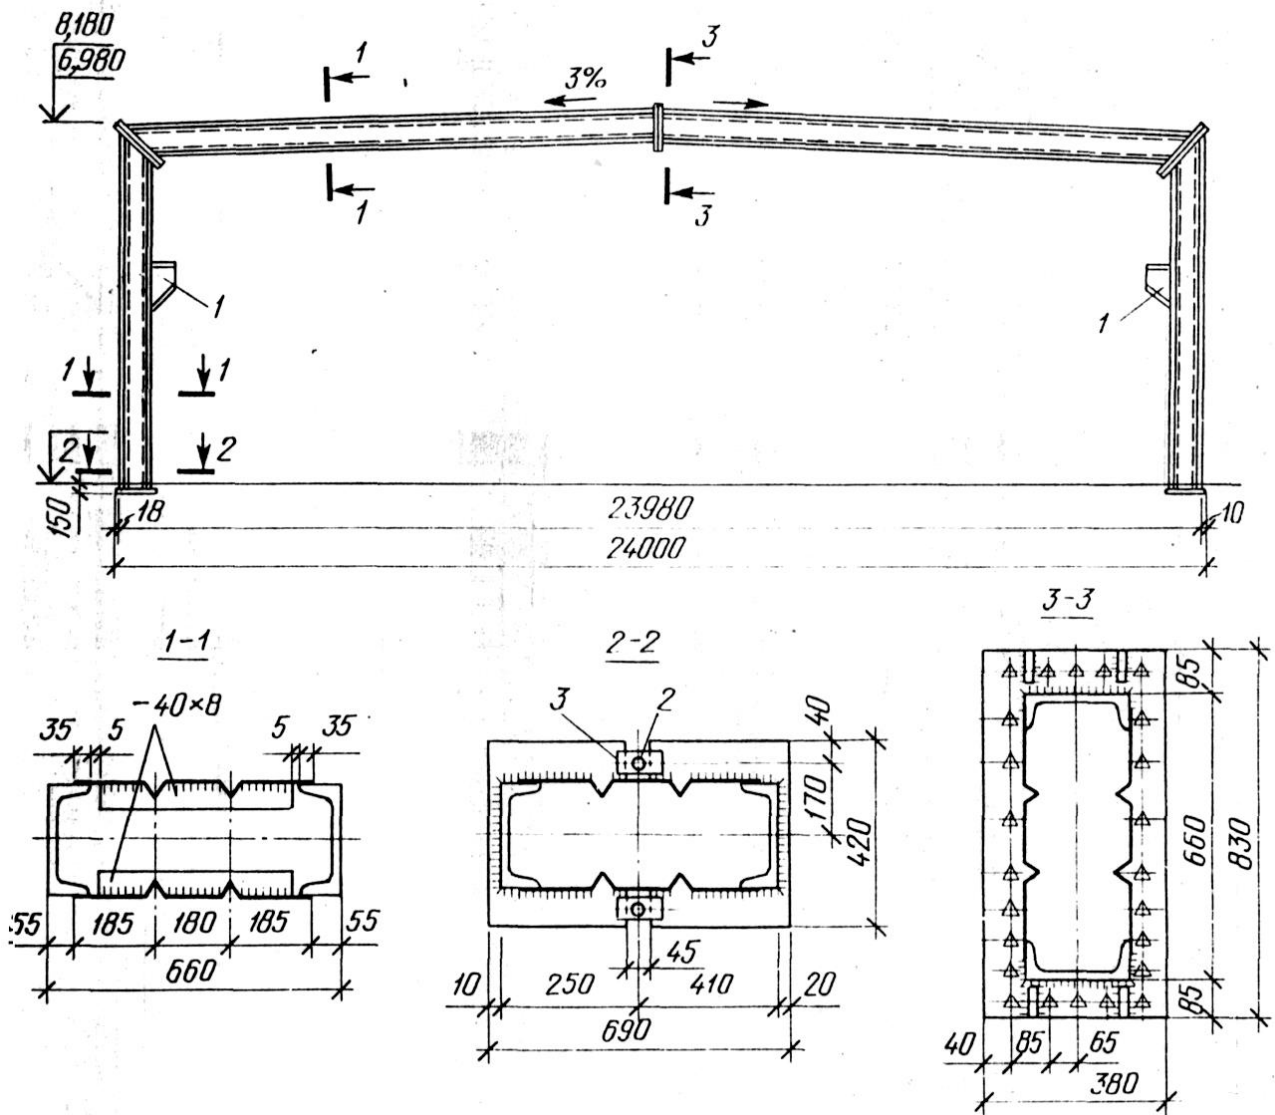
Рамная конструкция коробчатого сечения:
